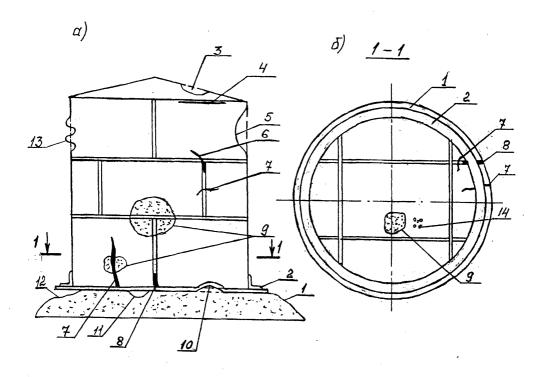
Повреждения стальных цилиндрических резервуаров а - разрез; б - план днища; 1 - окрайка днища; 2 - упорный уголок; 3 - вмятина; 4 - отрыв кровли от стен; 5 - местная потеря устойчивости; 6 - трещина по сварному шву, выходящая на основной металл; 7 - трещина по основному металлу; 8 - трещина по сварному шву; 9 - местная коррозия; 10 - хлопун (выпучина); 11 - местная просадка основания; 12 - зазор между краем днища и основанием; 13 - гофры; 14 - сквозные коррозионные отверстия
